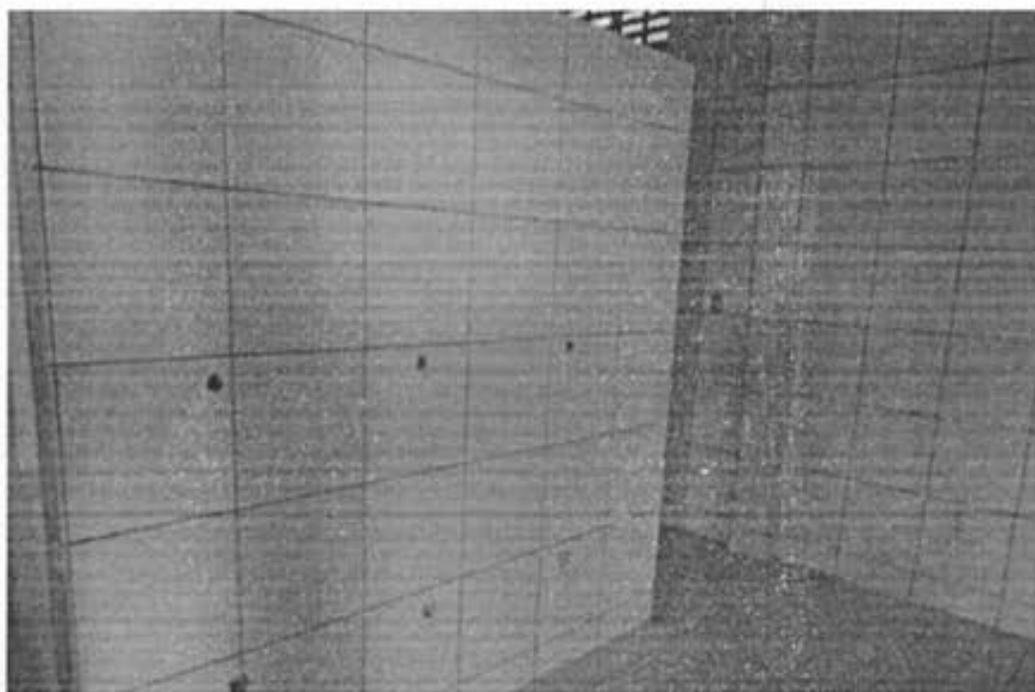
Vestiário – Alvenaria prevista para apoio da bancada do lavatório não foi executada
